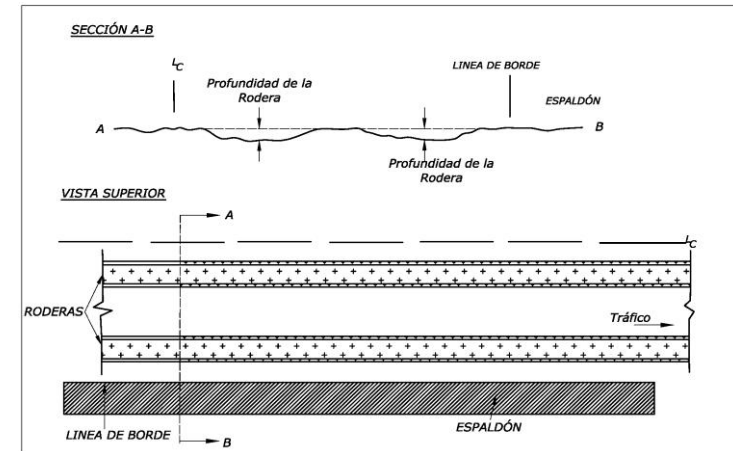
Esquema Roderas/Ahuellamiento– Pavimento
